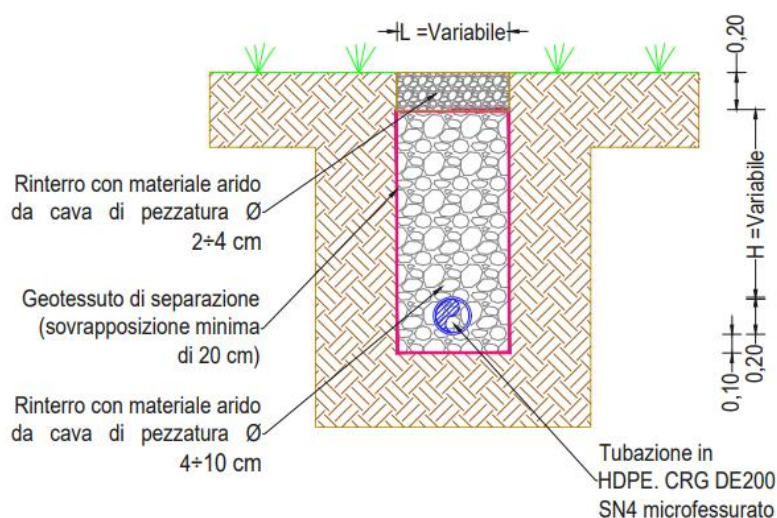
Sezioni tipo di scavo delle trincee drenanti, standard.
